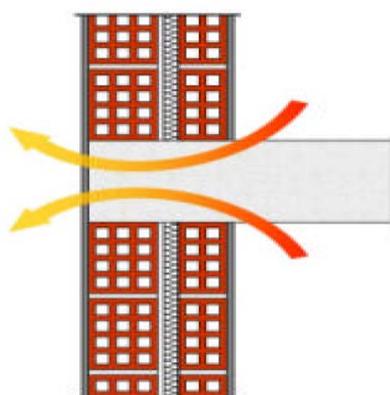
Alvenaria de tijolo à face dos elementos de betão [30]
